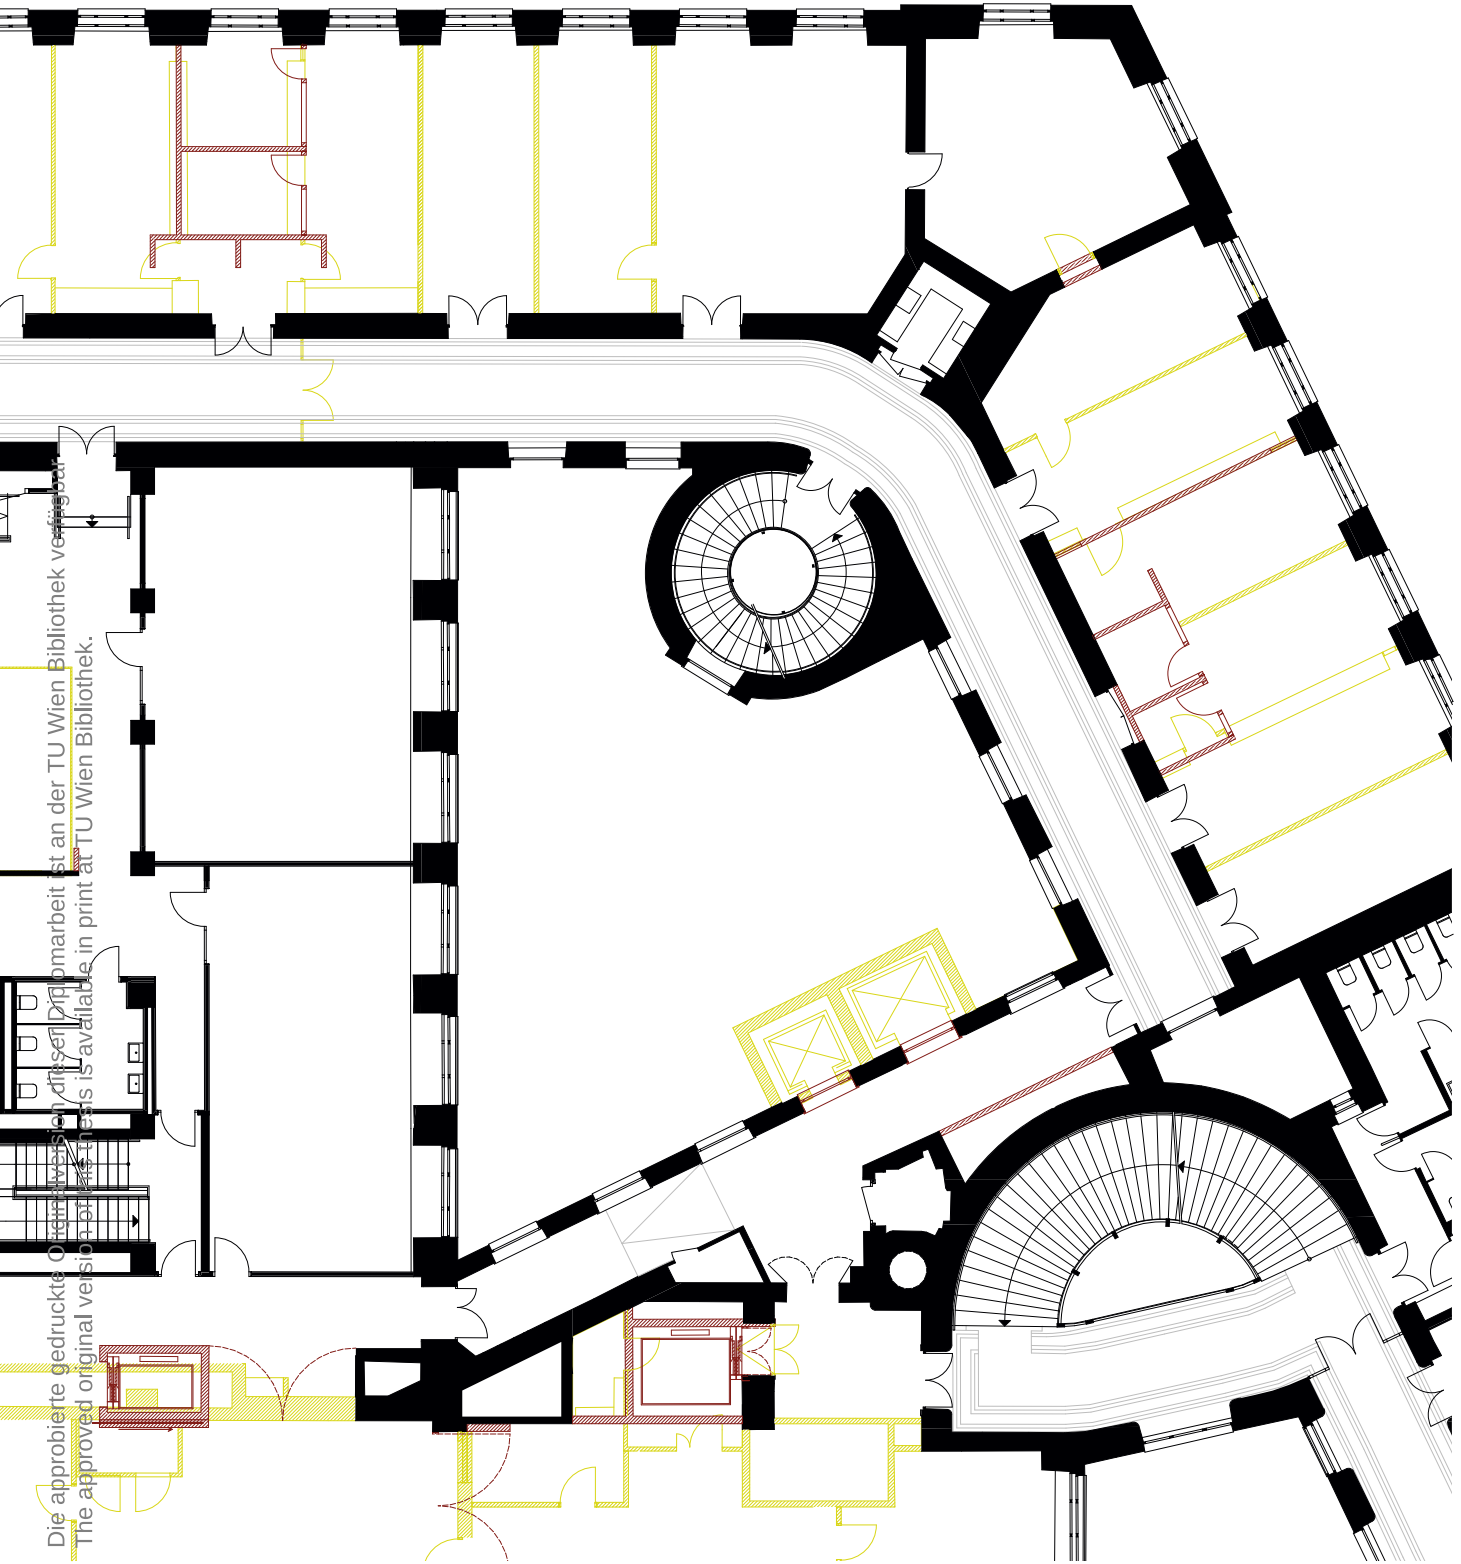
Entwurfsplan Grundriss 2. Obergeschoß
